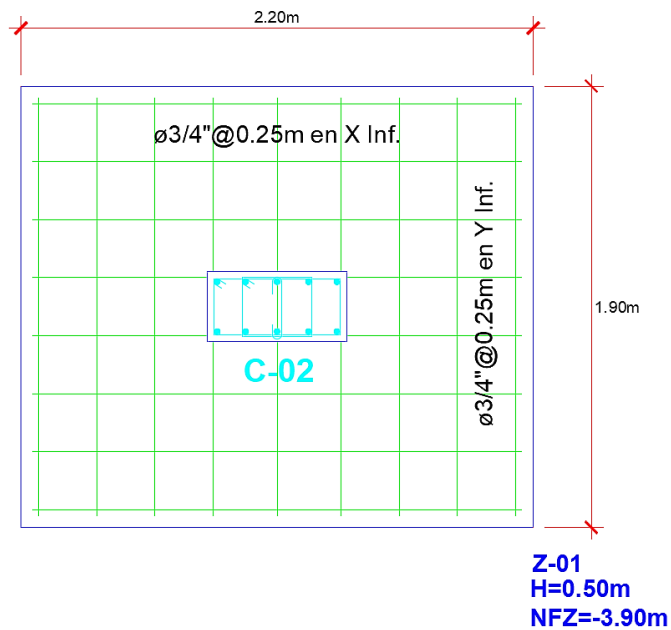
Detalle del refuerzo en concreto armado vista en planta (Zapata-Geotextil)
